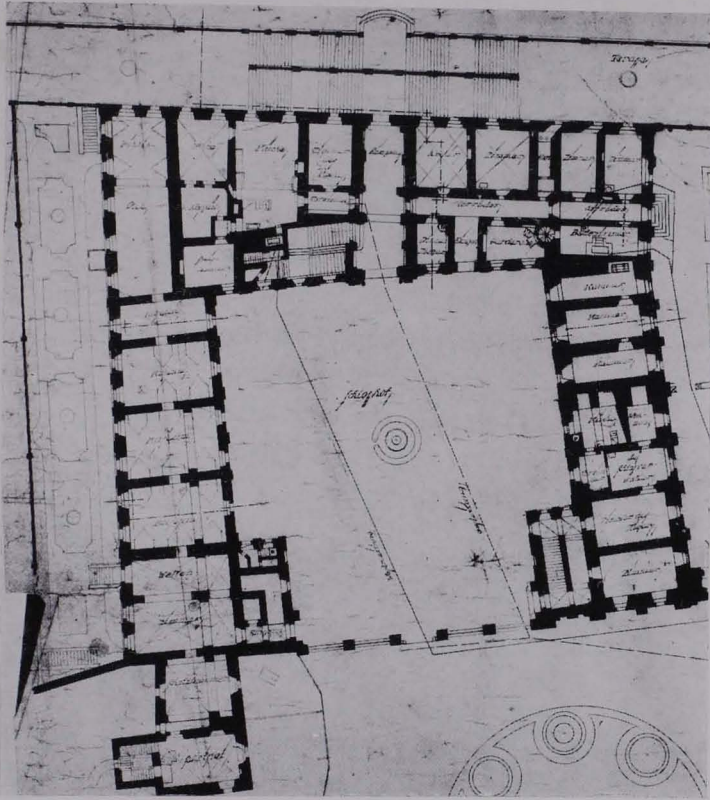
Dux, Neues Schloß. Grundriß Parterre
